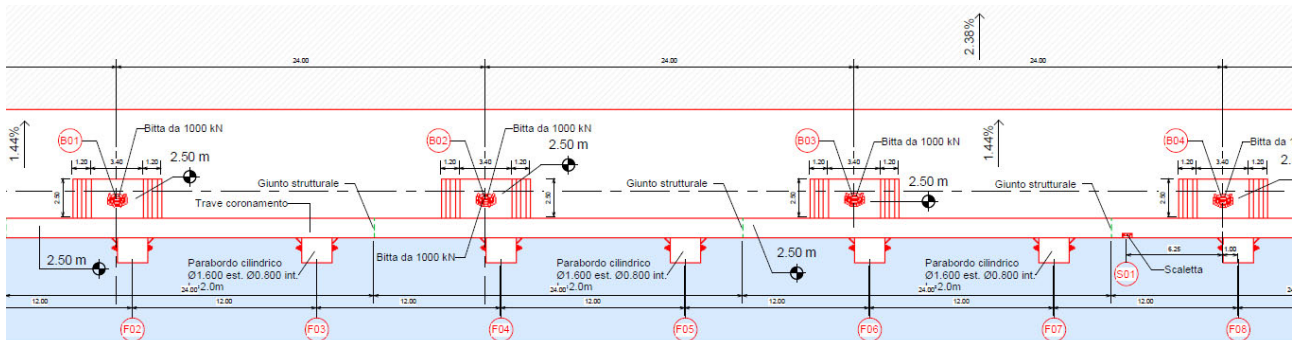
Estratto da Sezione trasversale e particolari – progetto del 1987
